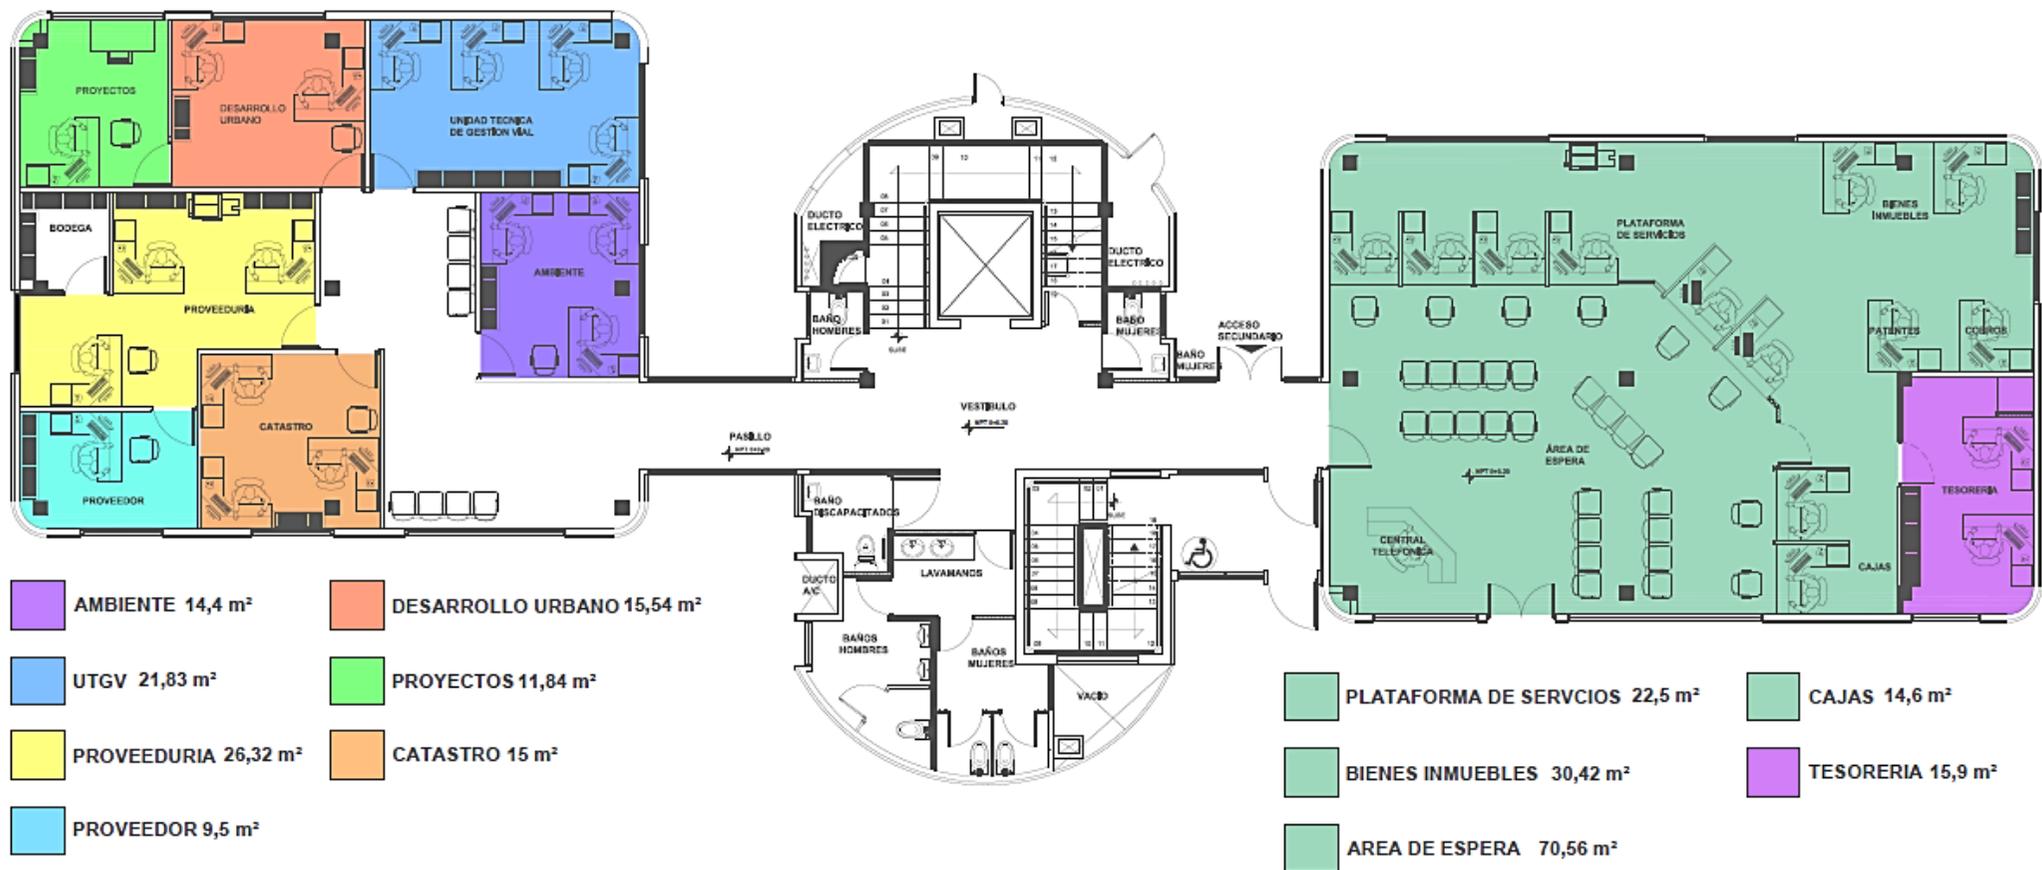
Distribución de oficinas en planta arquitectónica, nivel 01
